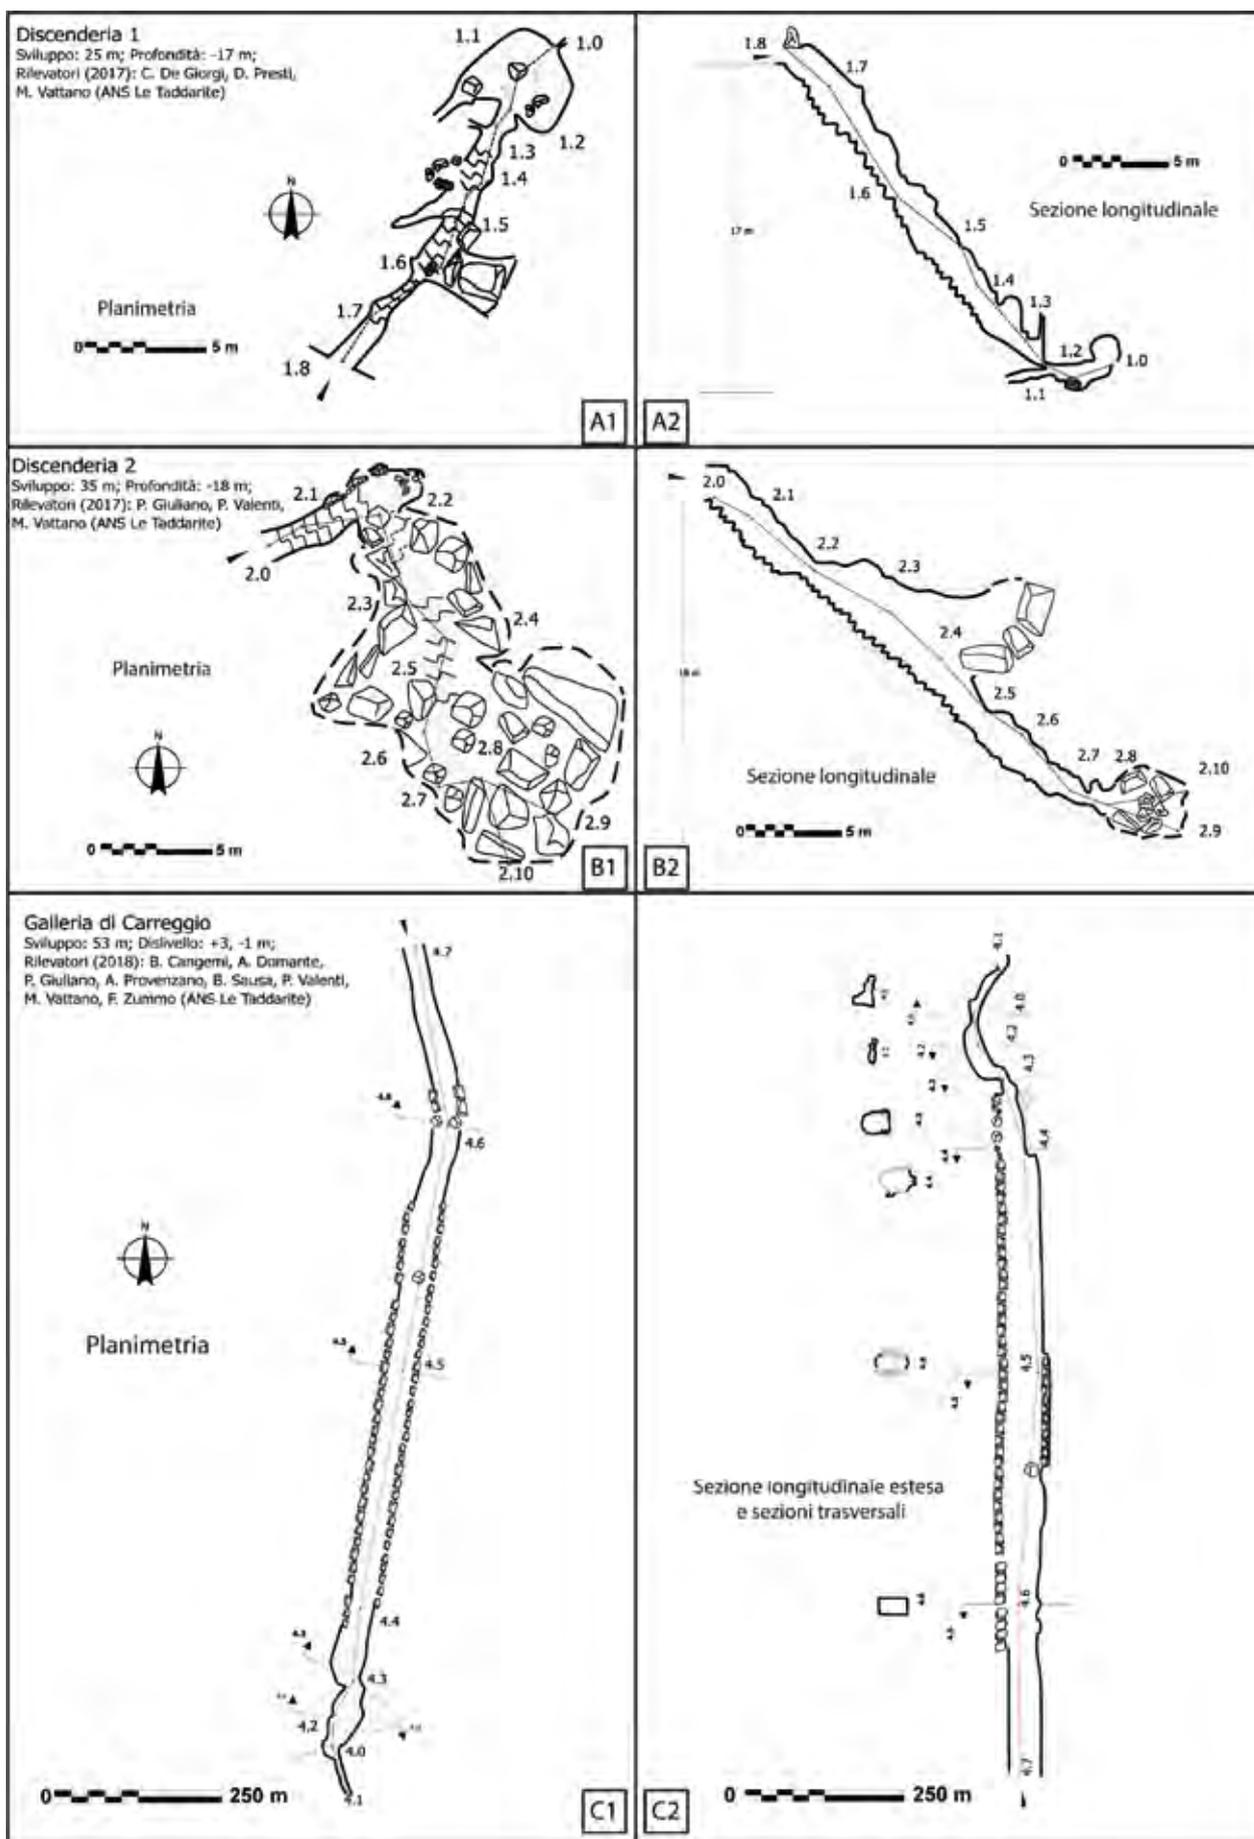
Rilievi topografici ipogei con planimetria e sezione longitudinale estesa. A1, A2: Discenderia 1; B1, B2: Discenderia 2; C1, C2: Galleria di Carreggio.
